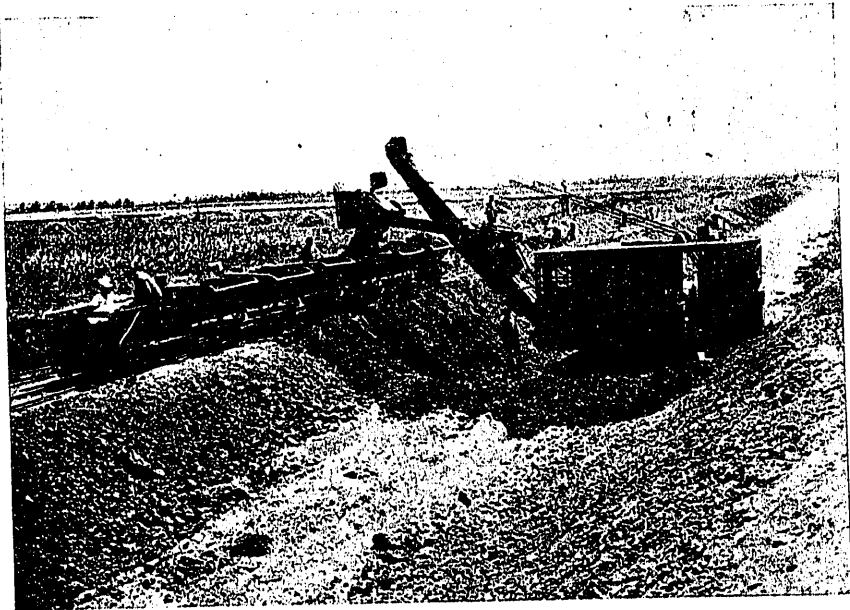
Excavadora de cuchara abriendo el cajero del canal
